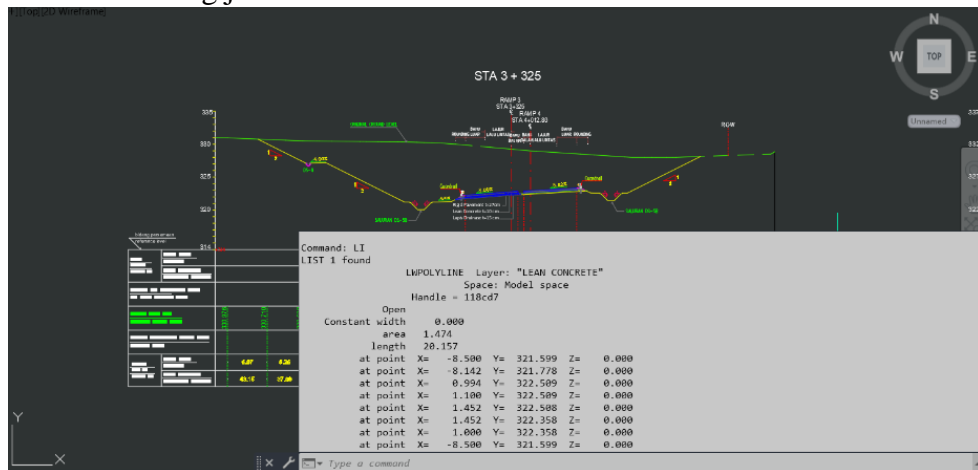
Gambar Cross Section Jalan Tol Ramp 3 STA 03+325
